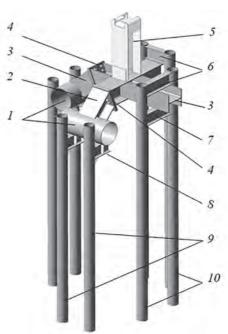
Фрагмент конструкции металлического свайного фундамента:
